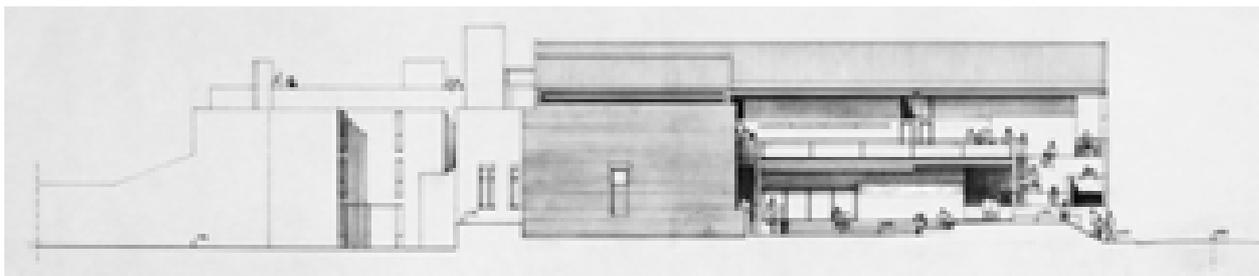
Prospetto Est, stato attuale –09/12/1997 (AABS-1996.991)
